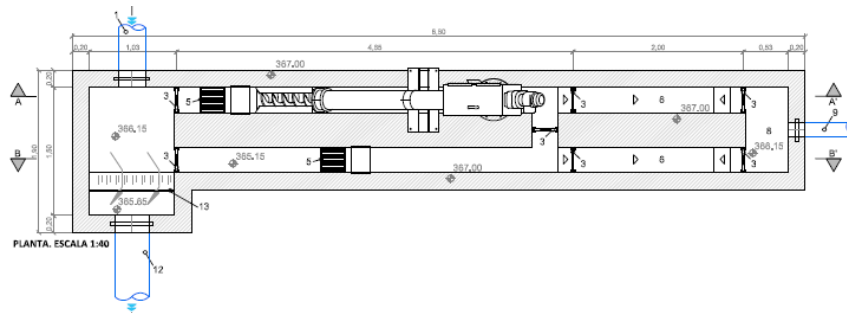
PLANTA DEL PRETRATAMIENTO PROPUESTO
